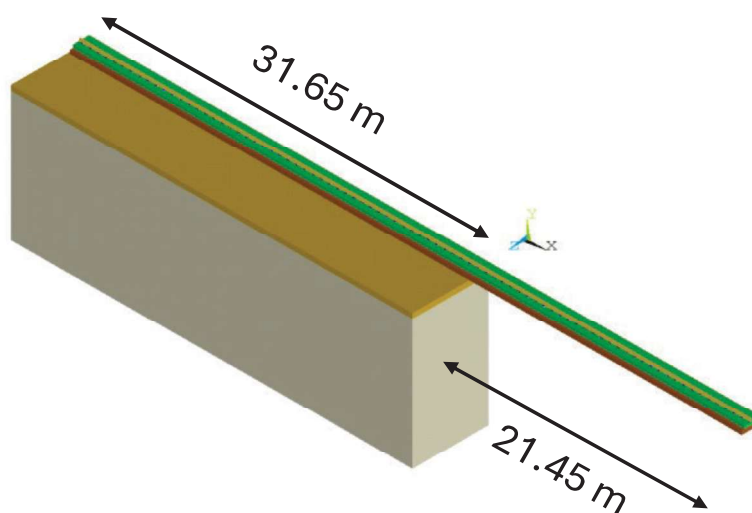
Transição aterro para túnel num sistema de via em laje.
